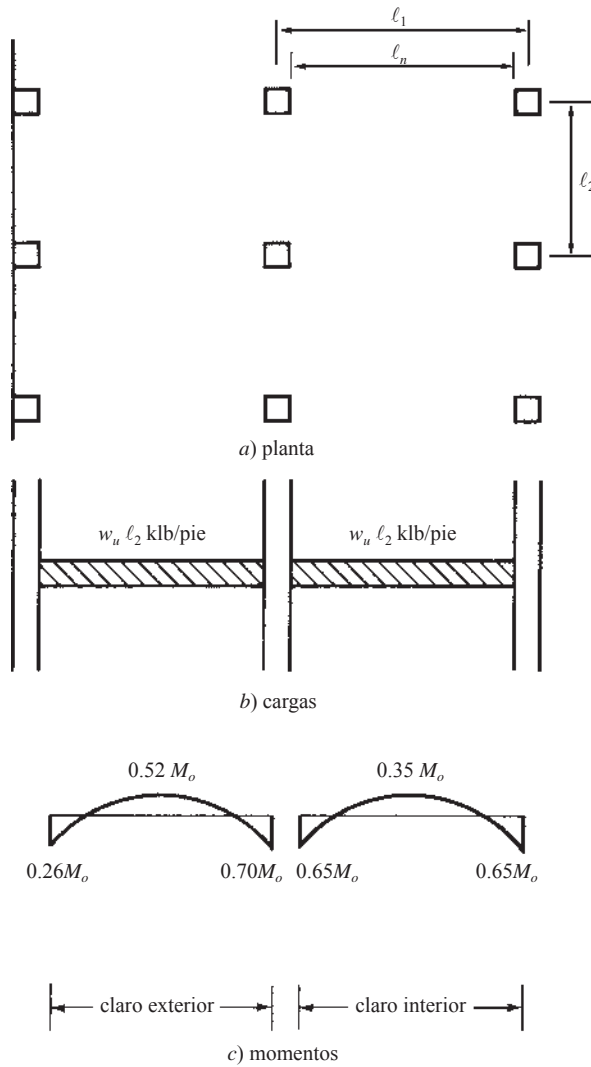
Ejemplos de momentos en una placa plana sin vigas de borde.
